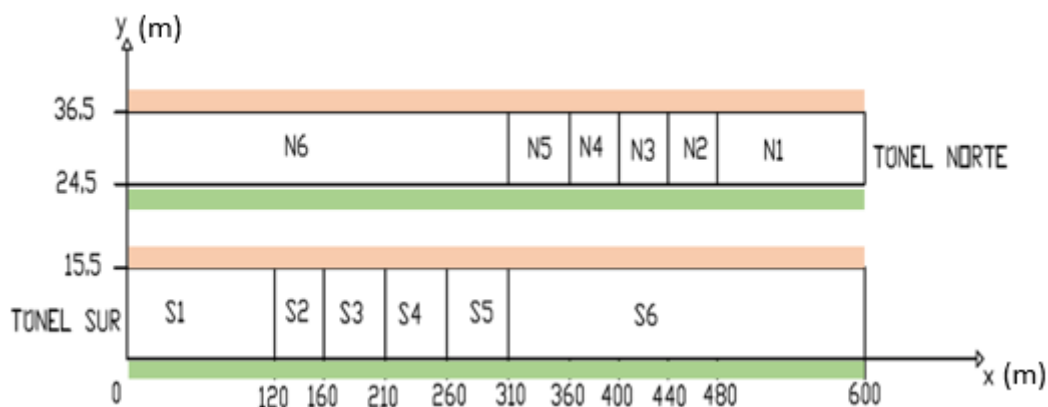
Escalones de iluminación para túnel Norte y Sur – vista planta
